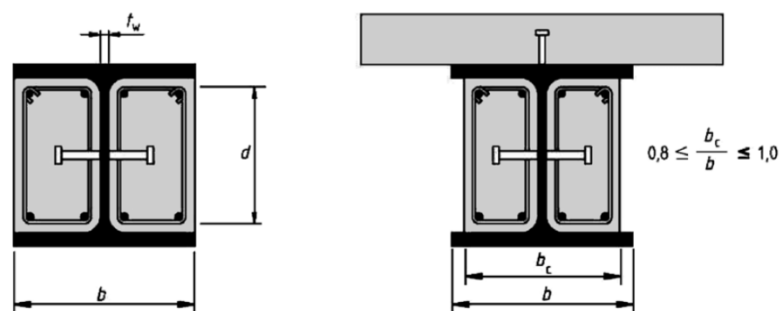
Типовые поперечные сечения сталежелезобетонных балок с обетонированием стенки
